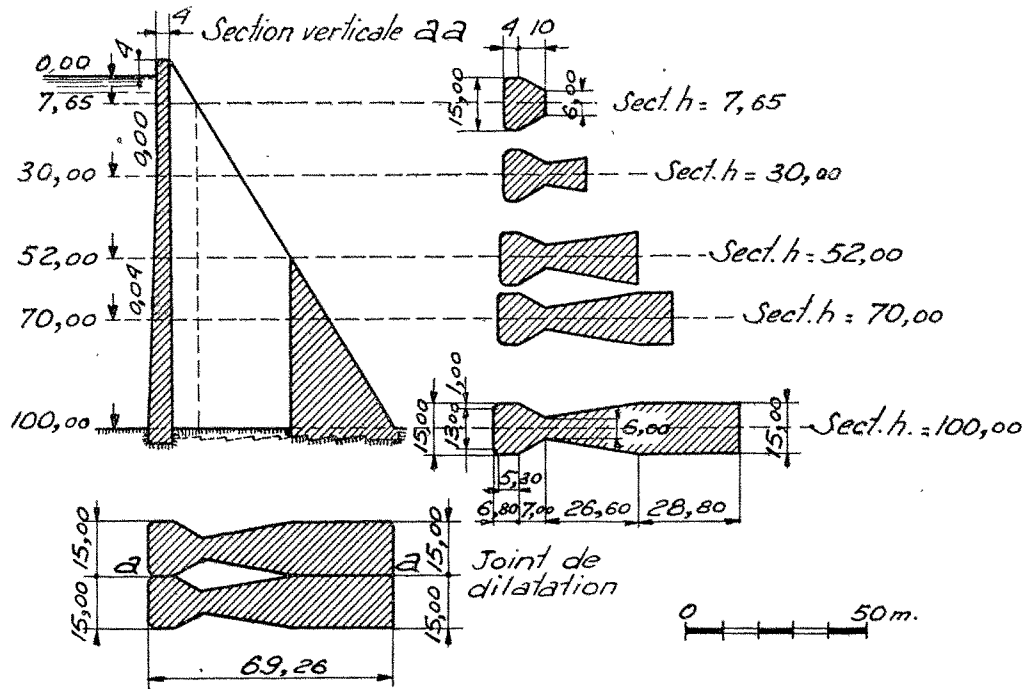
Barrage "à pilastres" de 100 m. de hauteur
